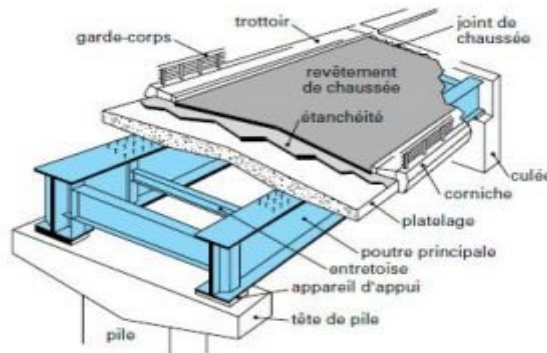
Coupe schématique d'un tablier mixte (bipoutre a entretoise)
